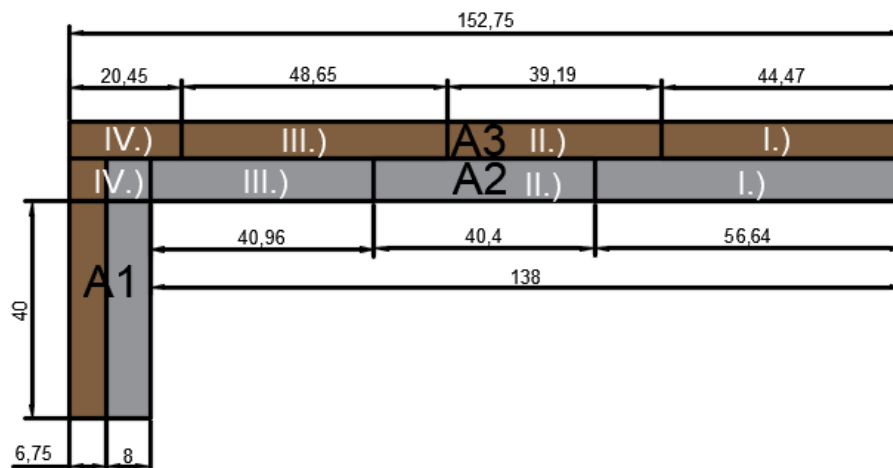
Sección en planta de la zona del muelle que dragar y rellenar
